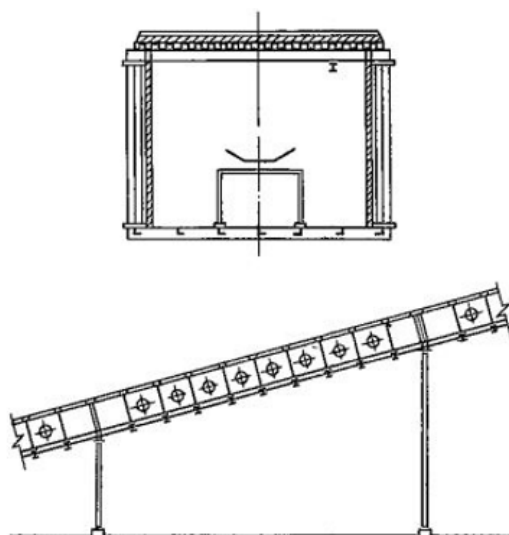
Пролетное строение конвейерной галереи с несущими конструкциями из сварных двутавровых балок
